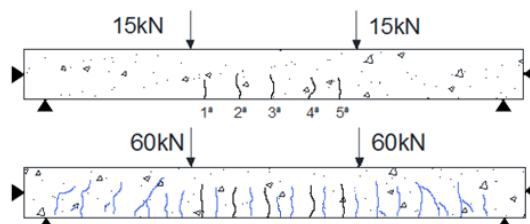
Formação e evolução das fissuras da Viga4.
